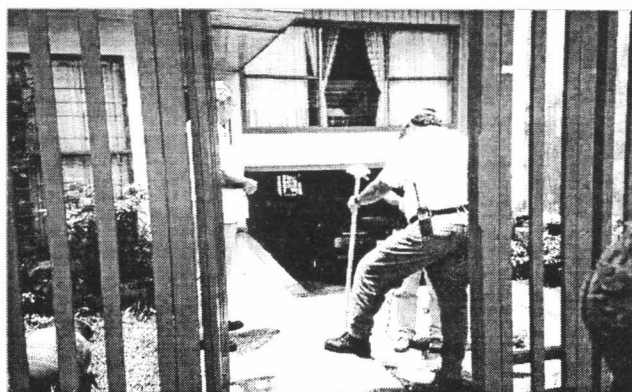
Casa construida por debajo del nivel de la calle en el centro de San Ramón, cerca de Palí
